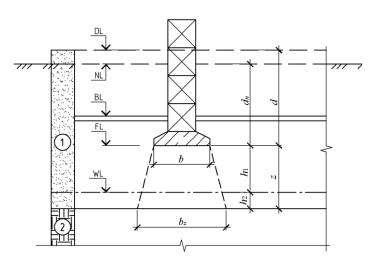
Расчетная схема для проверки расчетного сопротивления по подстилающему слою грунта: I – грунт верхнего слоя: 2 – грунт подстилающего слоя
